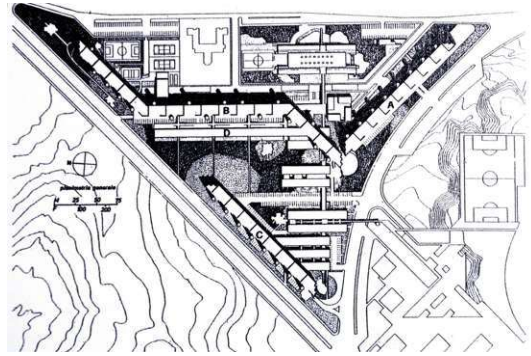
Lageplan Vigne Nuove, Pasarelli
